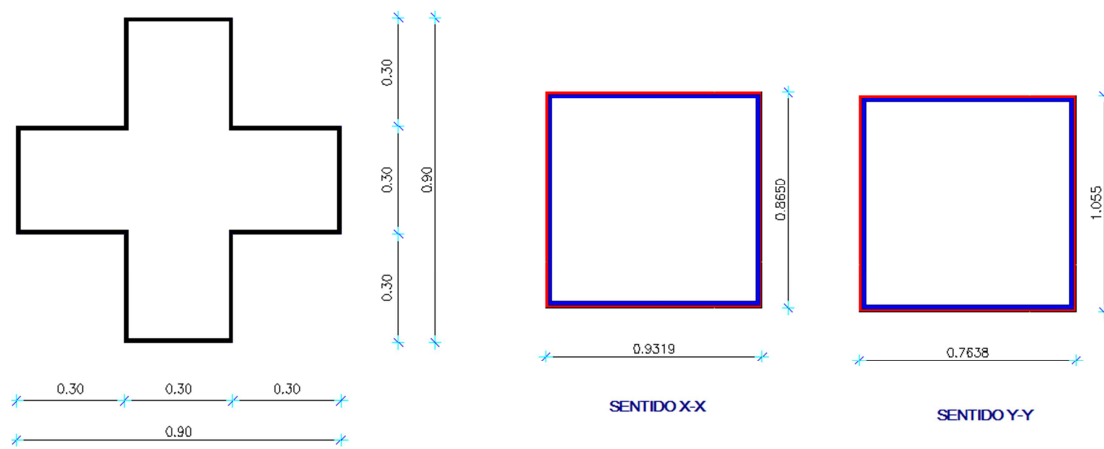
Secciones equivalentes reforzadas para columna cruz de 90x90cm
